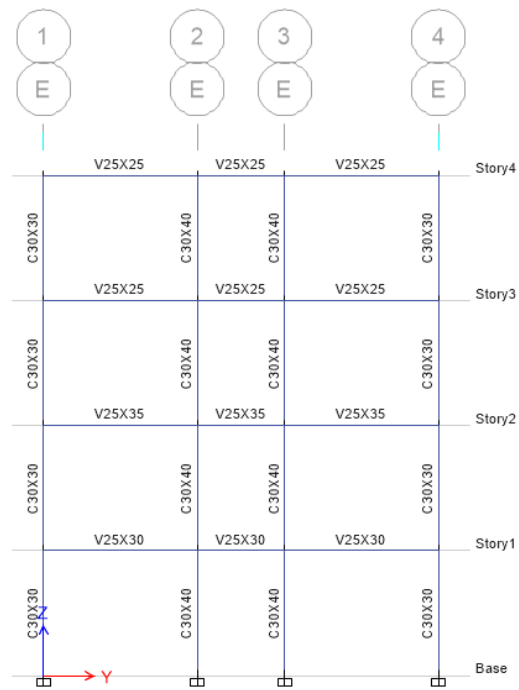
Vista de secciones en elevación pórticos B e I, para hormigón armado
